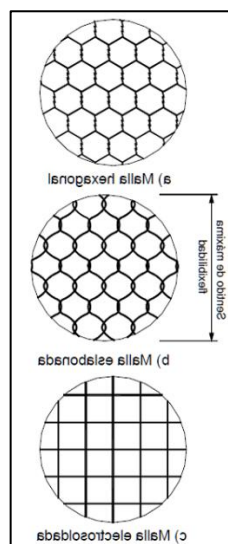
Tipos de mallas utilizadas en la construcción de gaviones.
